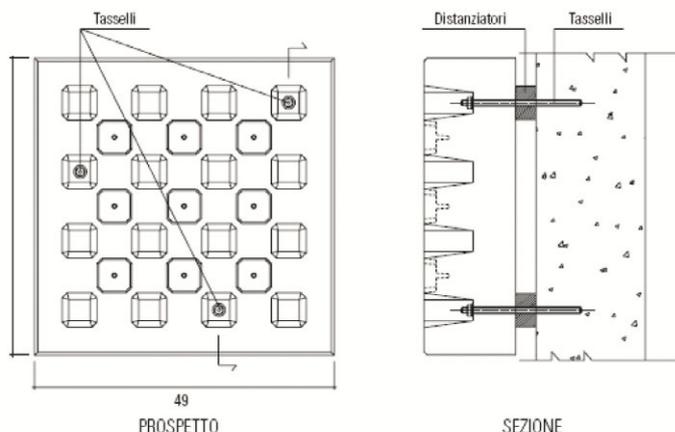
Rivestimento pareti galleria Sub-alvea – Particolari formelle
